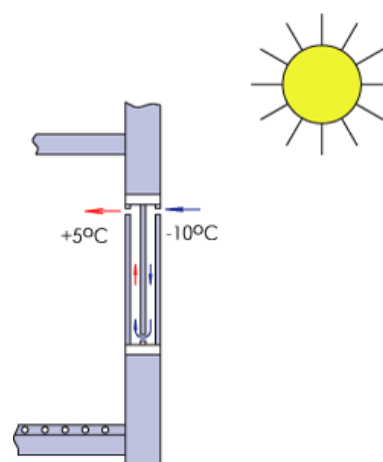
Вентиляция помещений при помощи предварительного подогрева наружного воздуха, подаваемого через окна специальной конструкции
